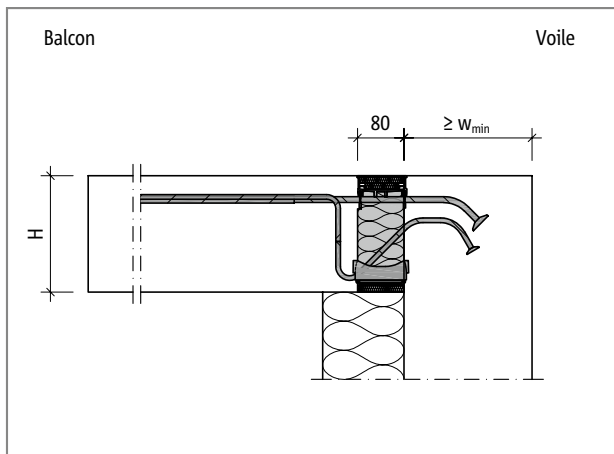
Schöck Isokorb® T Type K-O : Raccordement mural vers le bas avec isolation externe
